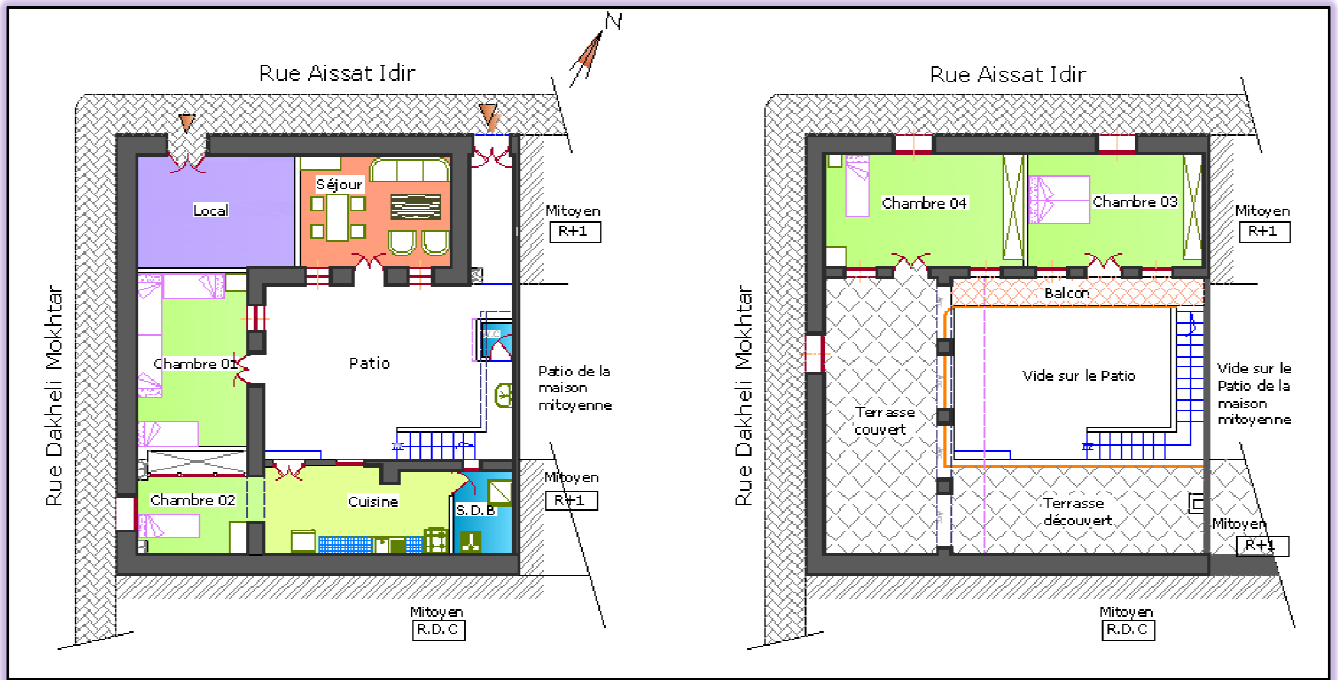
Plan R.D.C (à gauche), Plan 1^{er} Étage (à droite) (Maison N°1)
